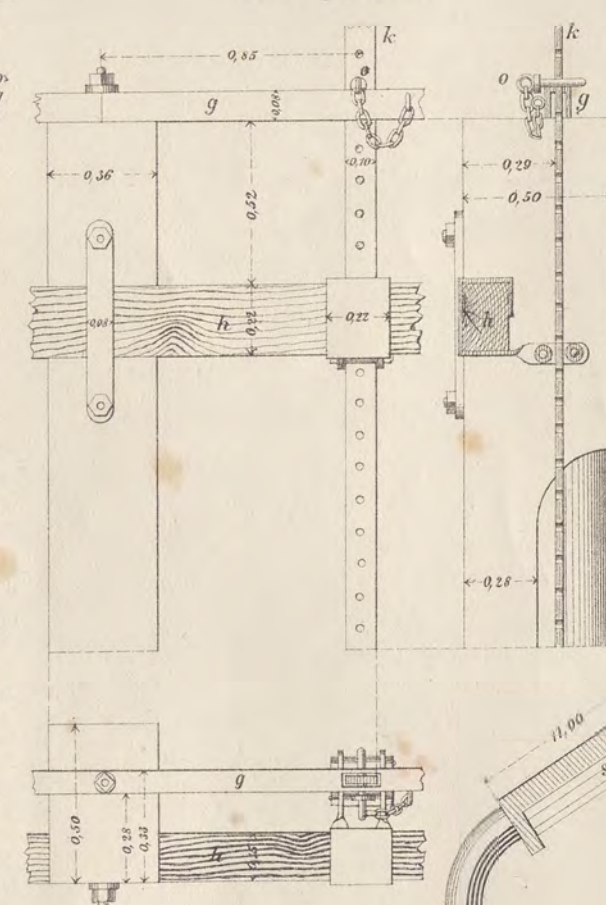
<sup>a</sup> Sezione orizzontale nel piano delle paratoie alzate.
